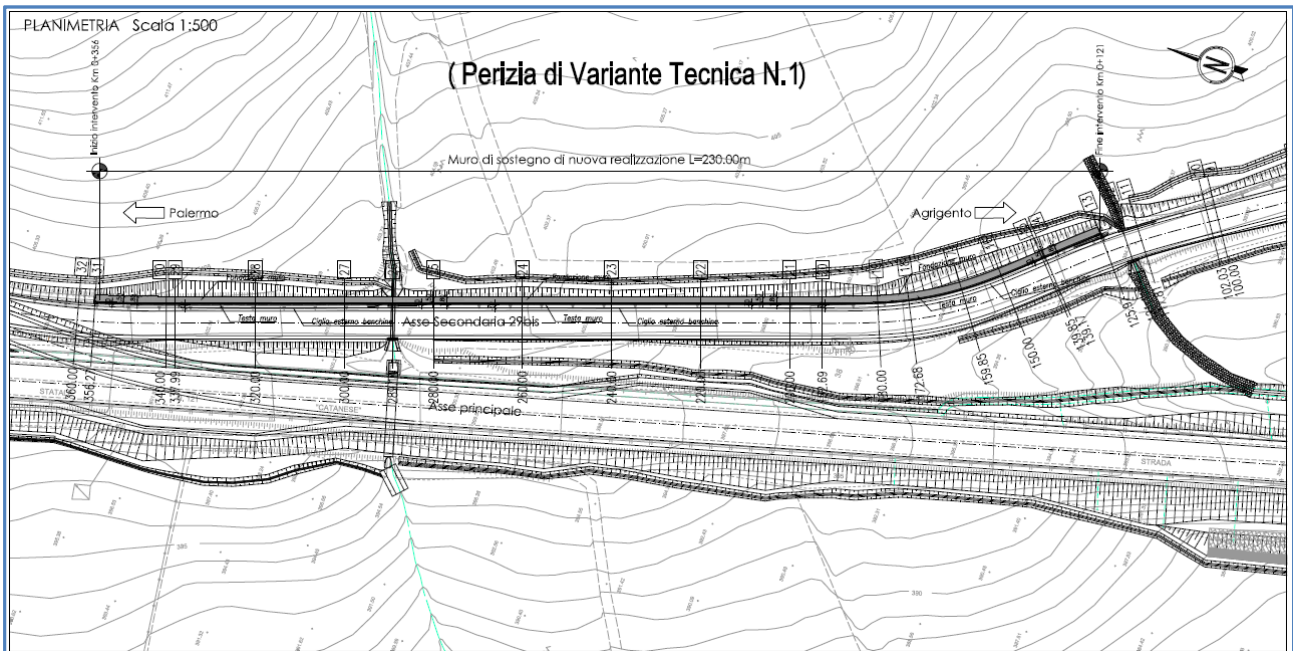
Stralcio planimetrico con l’ubicazione del nuovo muro di sostegno secondo le previsioni di P.V.T.1 – Elaborato codifica PVVS\_W002\_50\_4137.
